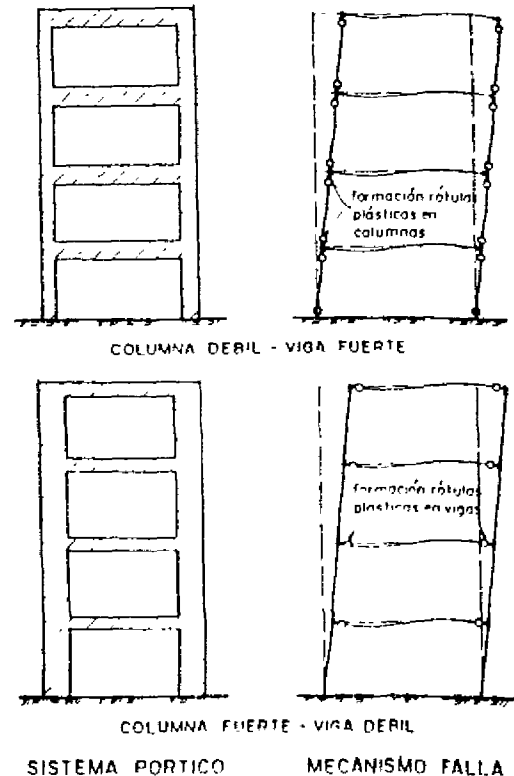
Formación de rótulas plásticas en vigas y columnas:
